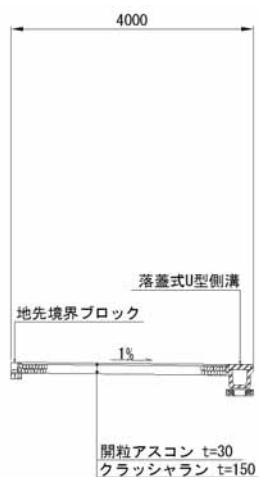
(6) 道路標準断面図（自転車歩行者道）
